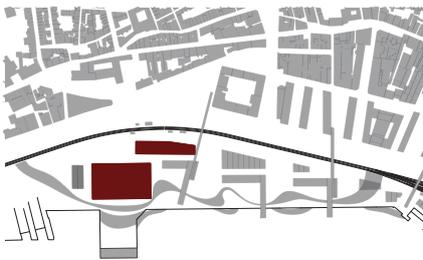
Planta esquemática da Proposta Arquitetónica, escola e residencia de estudantes
